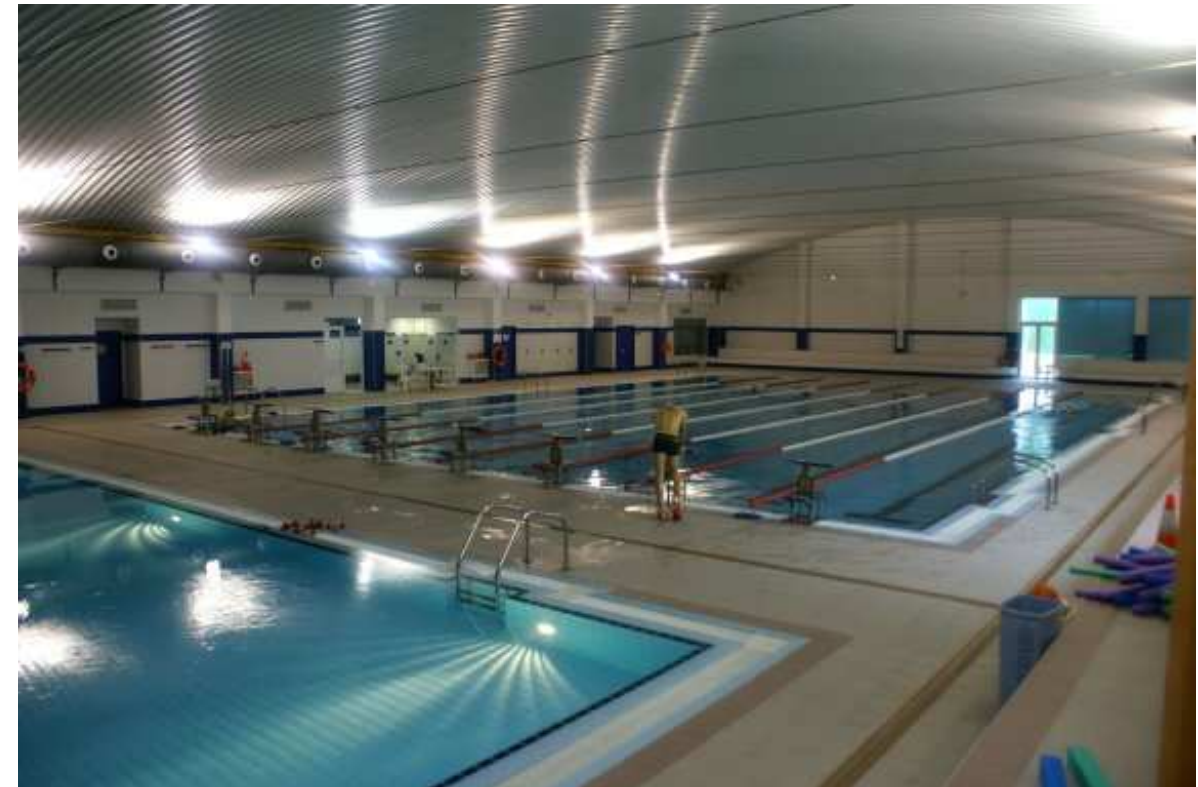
Cubierta autoportante con tirante de la piscina cubierta de Montijo (Badajoz). Fuente: aytobadajoz.es
